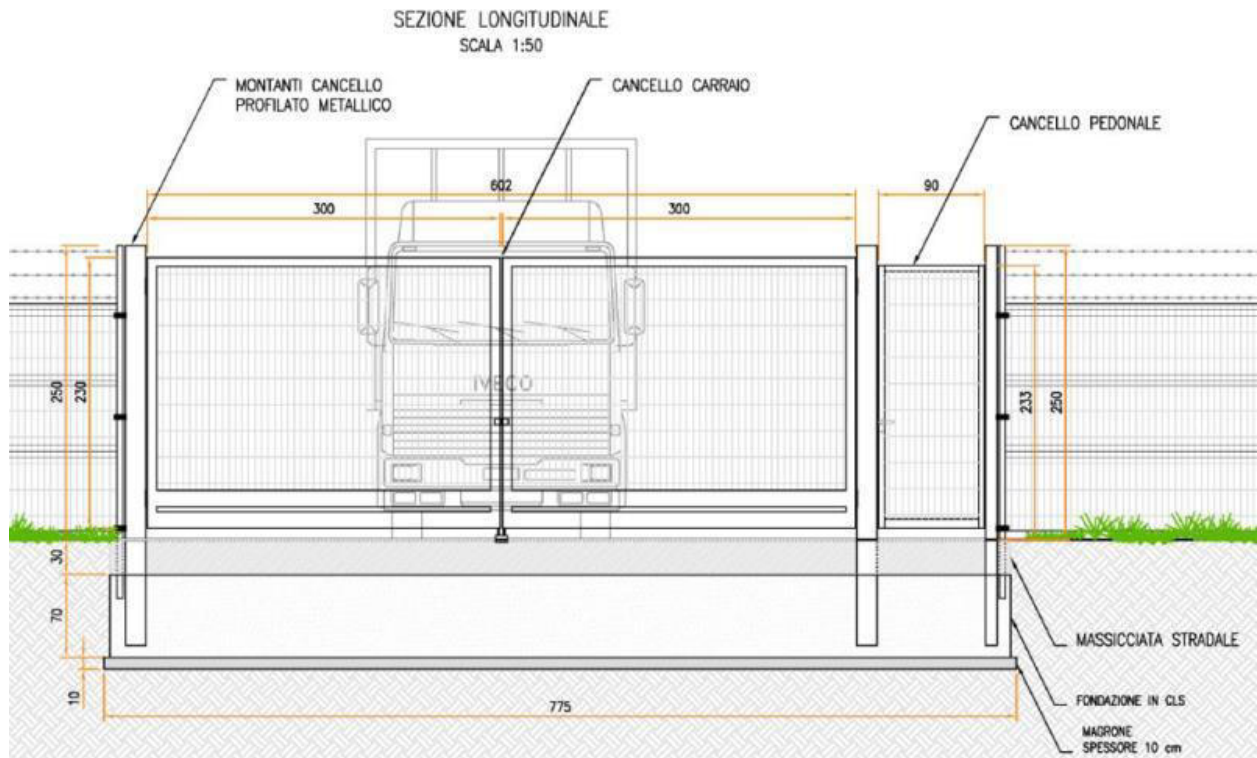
Sezione longitudinale accesso carraio e pedonale
